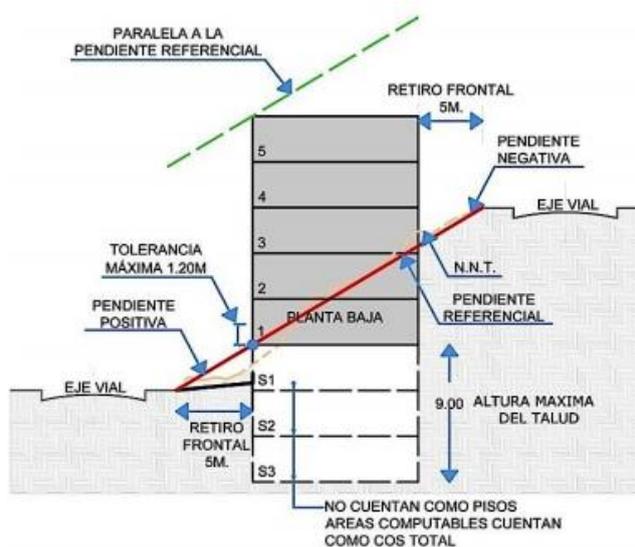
Vista en elevación para la definición de la planta baja (PB)
